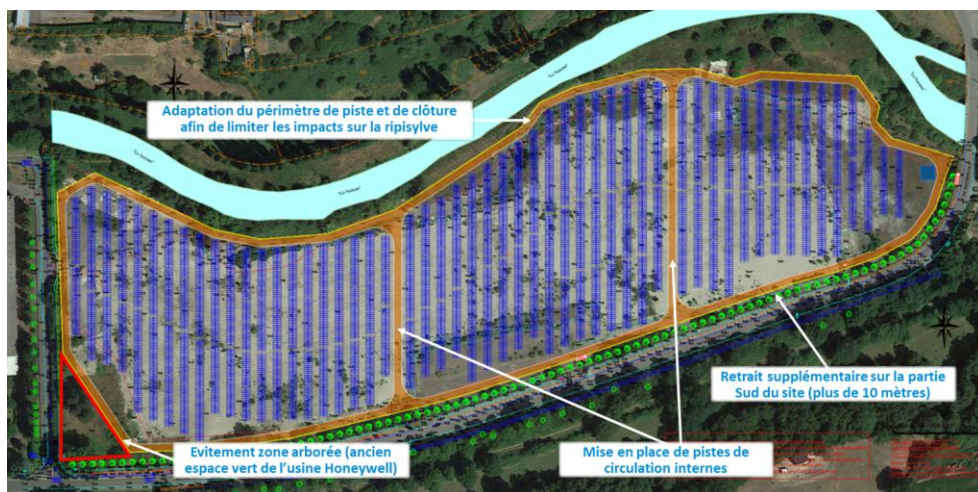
Variante V2 du plan d'implantation (Source : Trina Solar)
